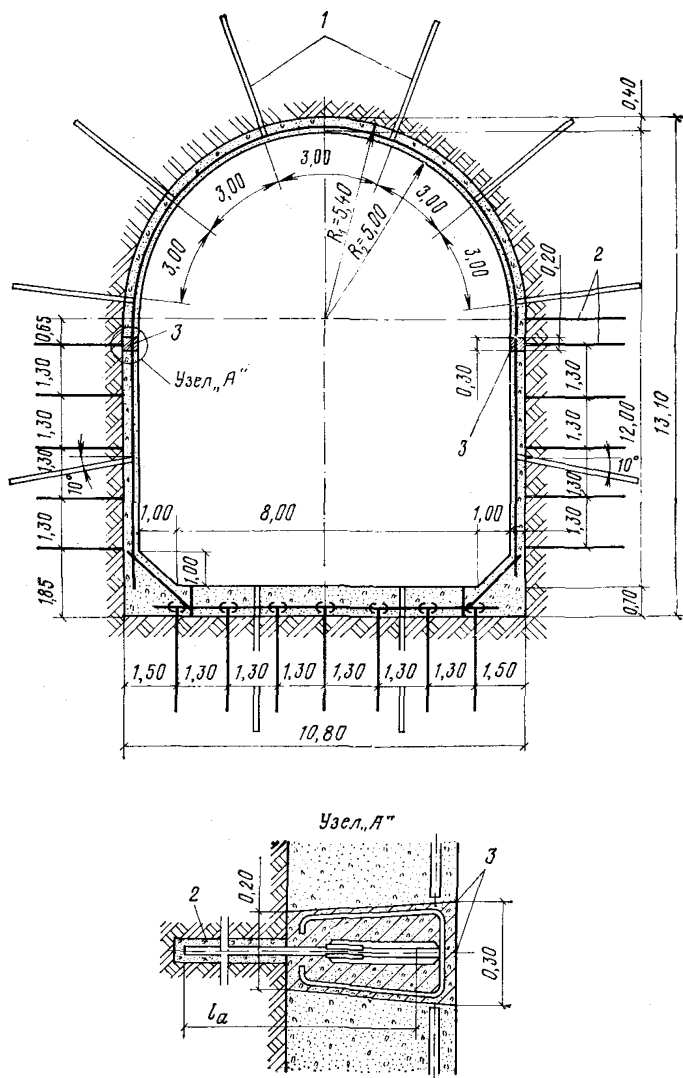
Пример железобетонной обделки, дренированной и прианкерванной к породе
